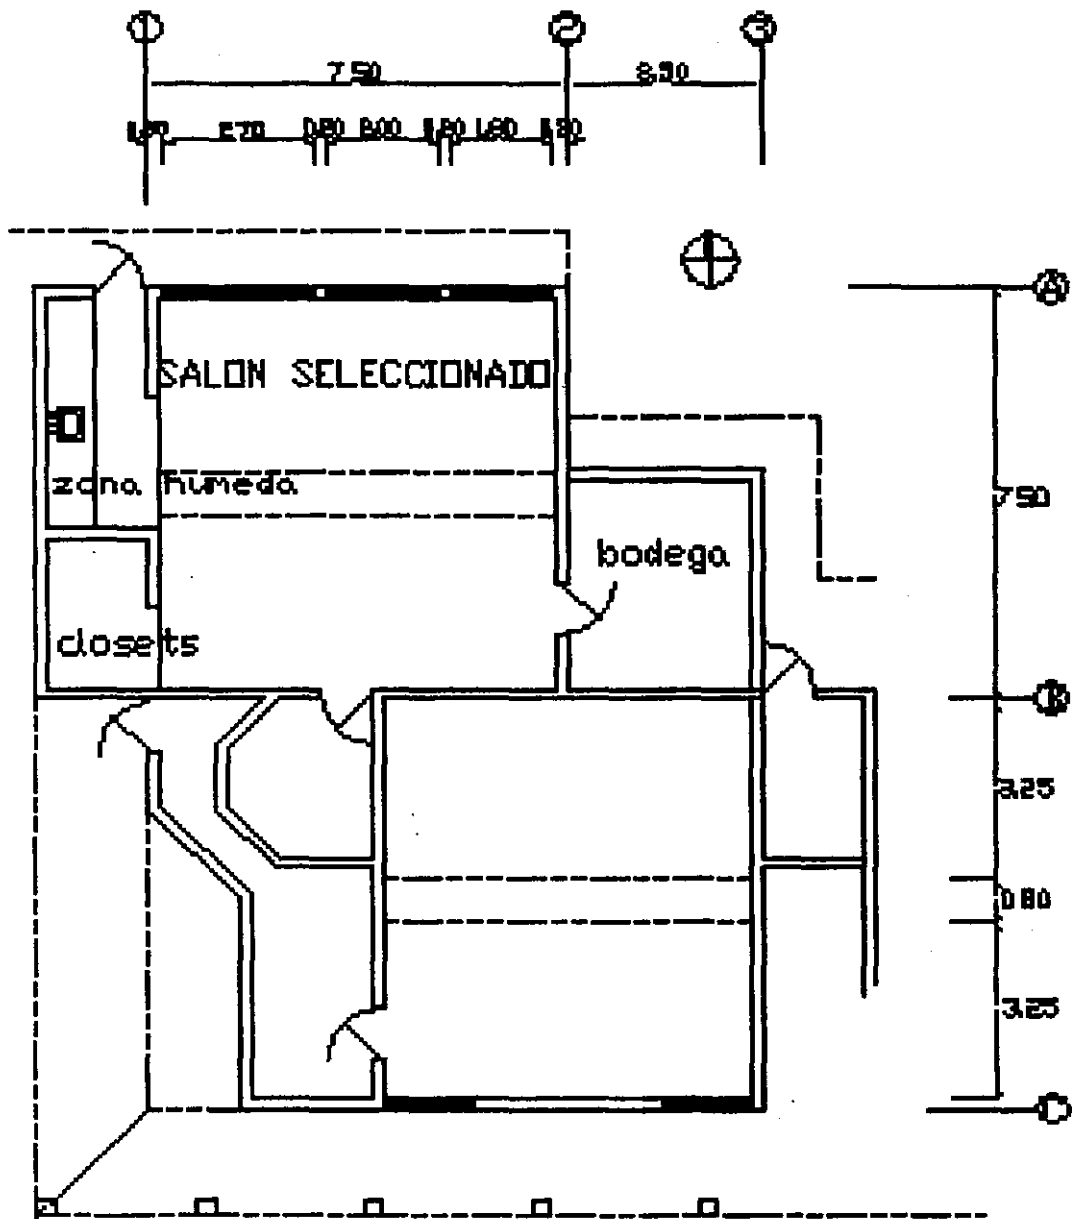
Planta arquitectónica del salón seleccionado para el estudio (metros)
